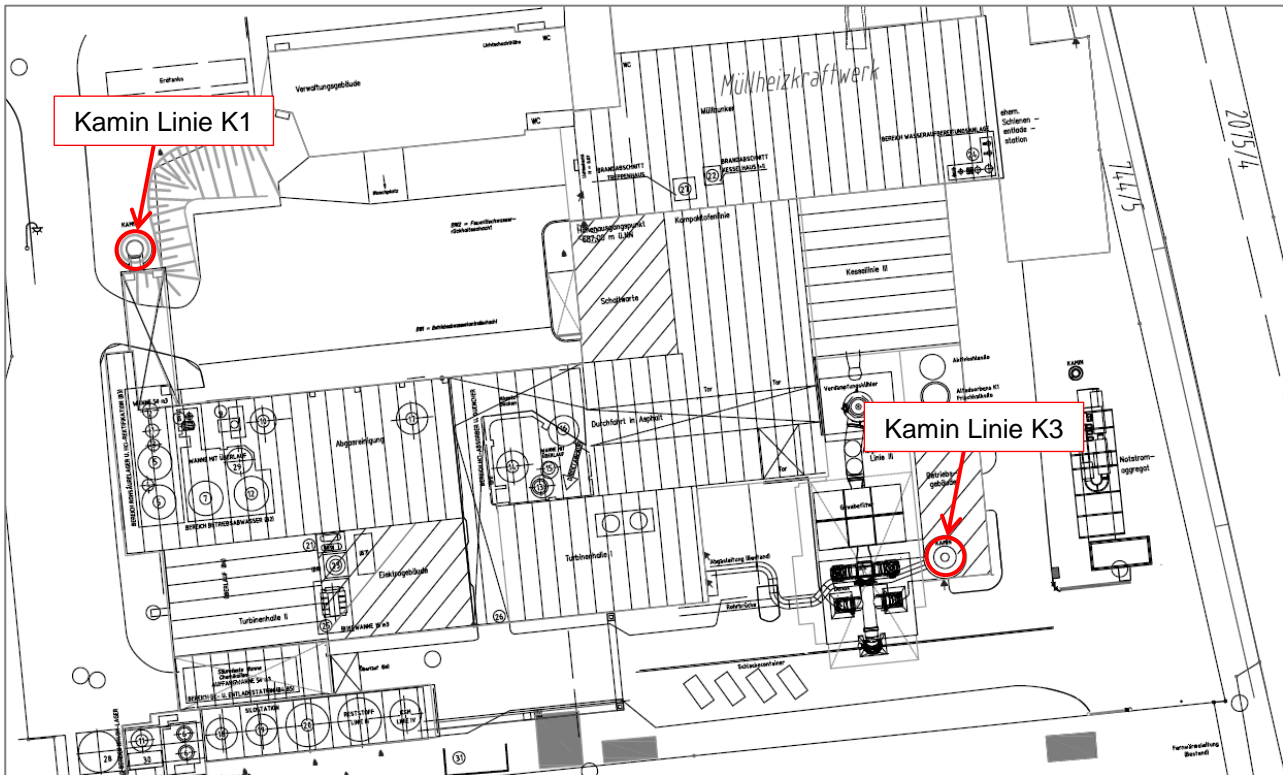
Auszug aus dem Lageplan der ZAK Kempten mit Markierungen der Quellen
